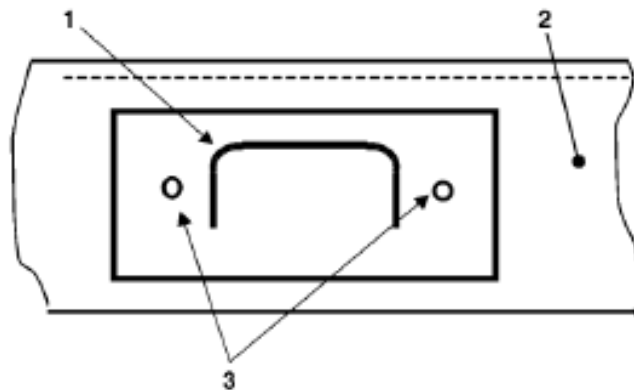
Esquema pernos de fijación. UNE-EN 12252
